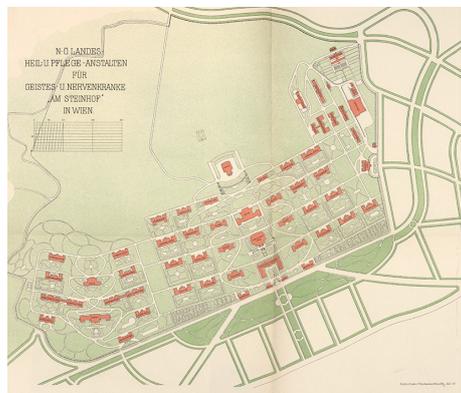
Lageplan Landesheil- und Pflegeanstalt Am Steinhof
